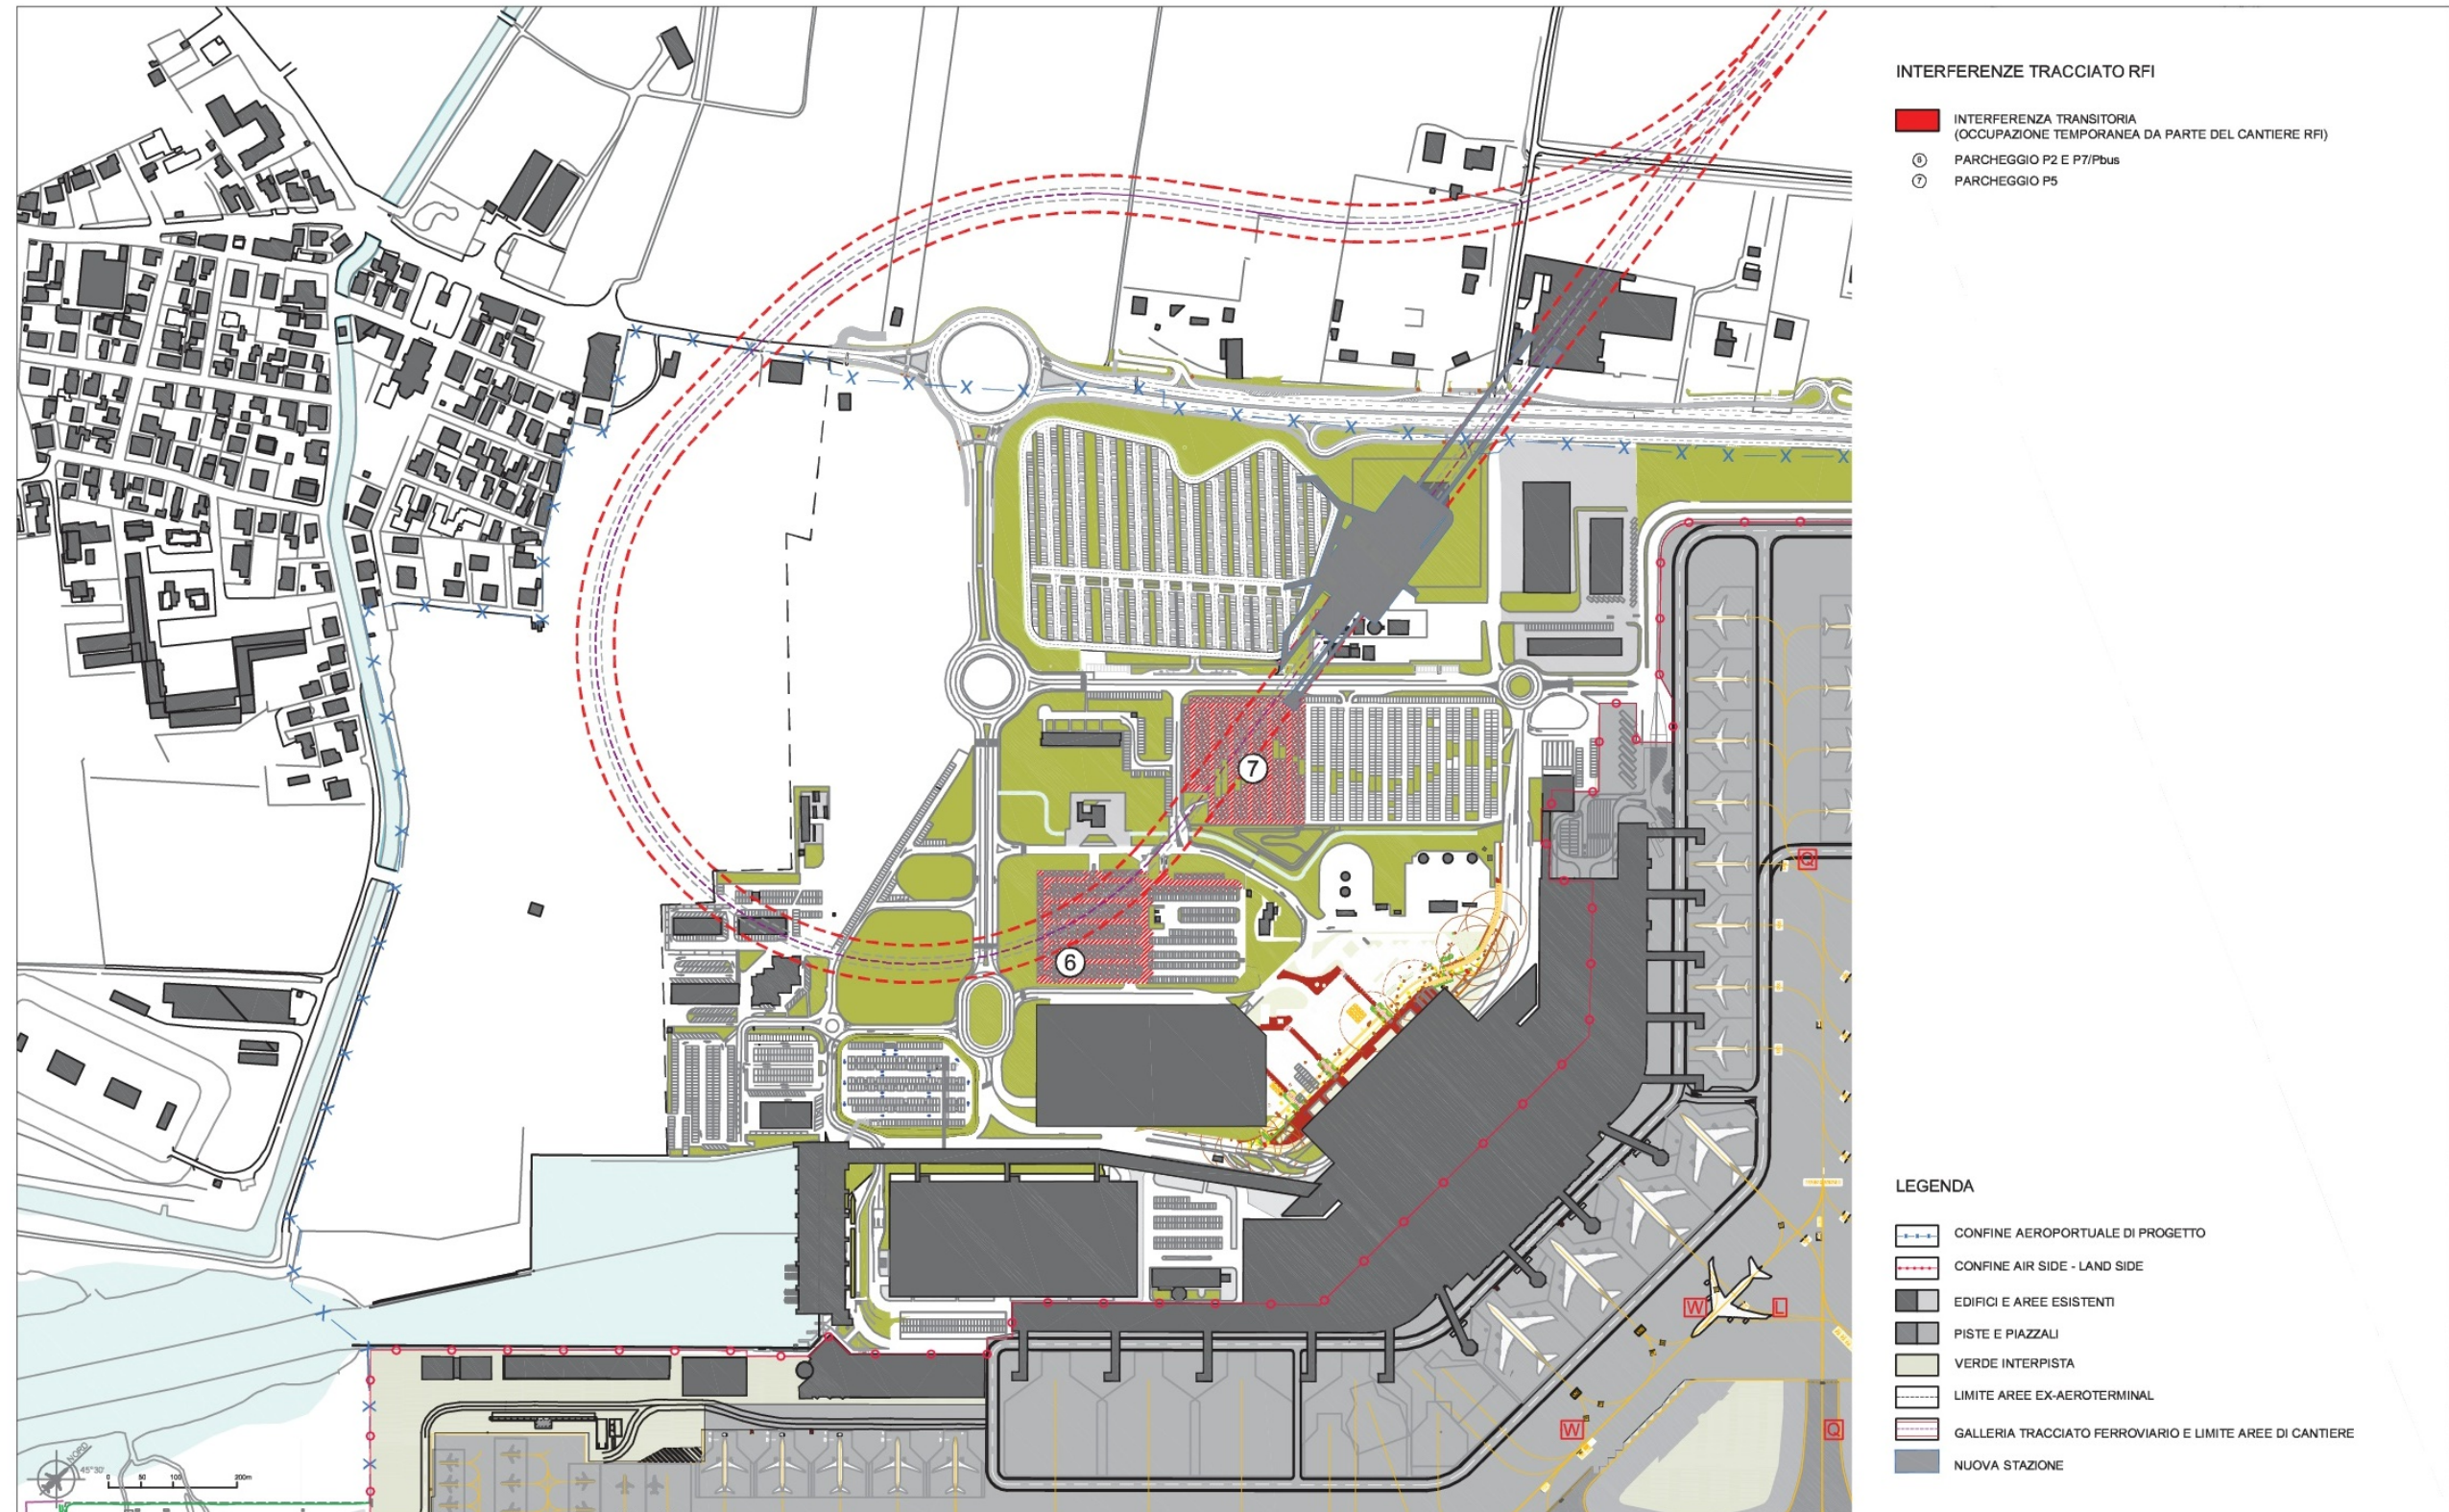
Planimetria con individuazione delle interferenze temporanee
